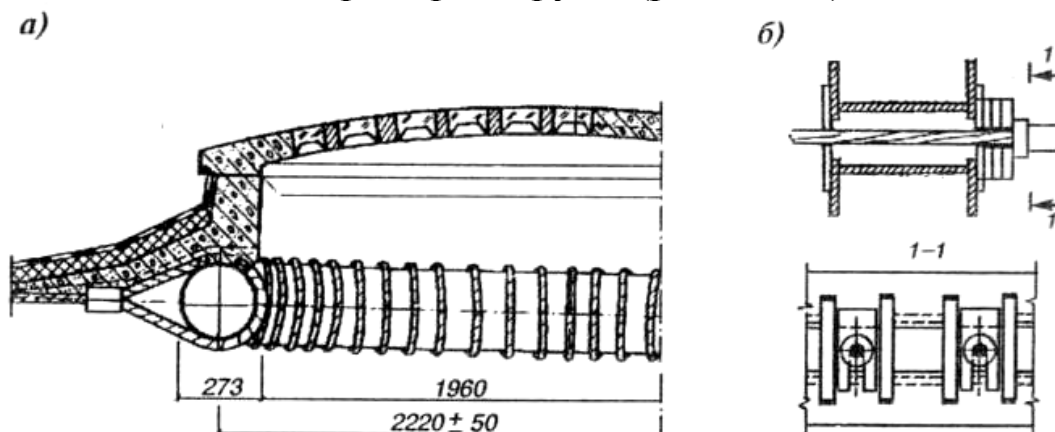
Центральные кольца вогнутых покрытий: а – из трубы; б – сварное из листов
